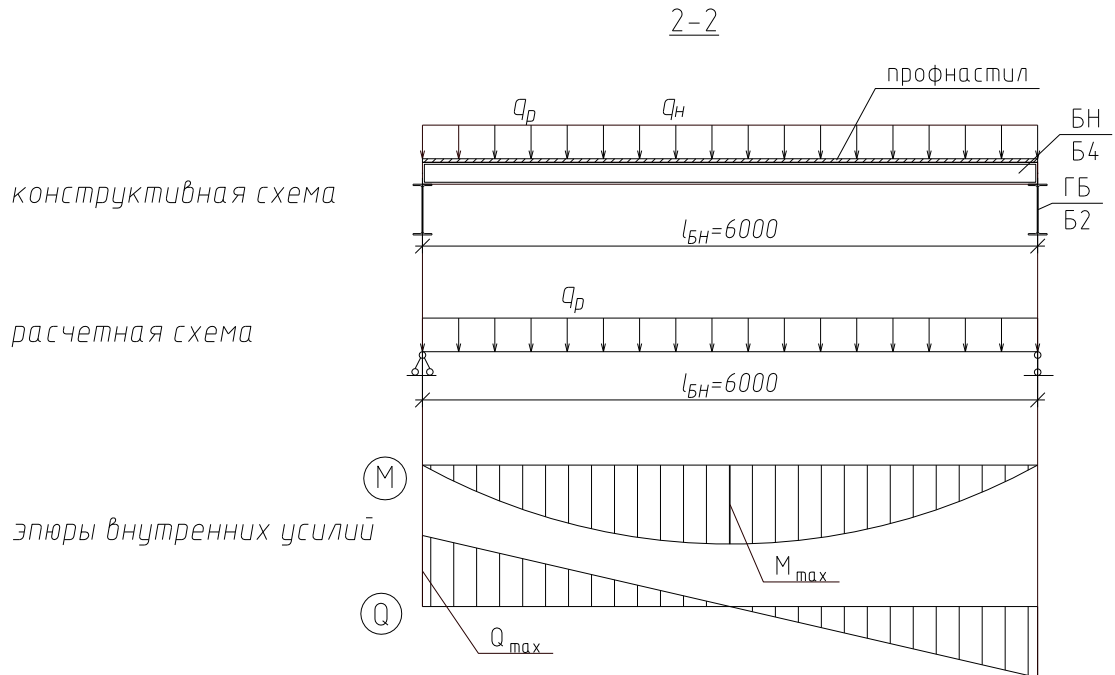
Компоновка ячейки балочной клетки перекрытия
